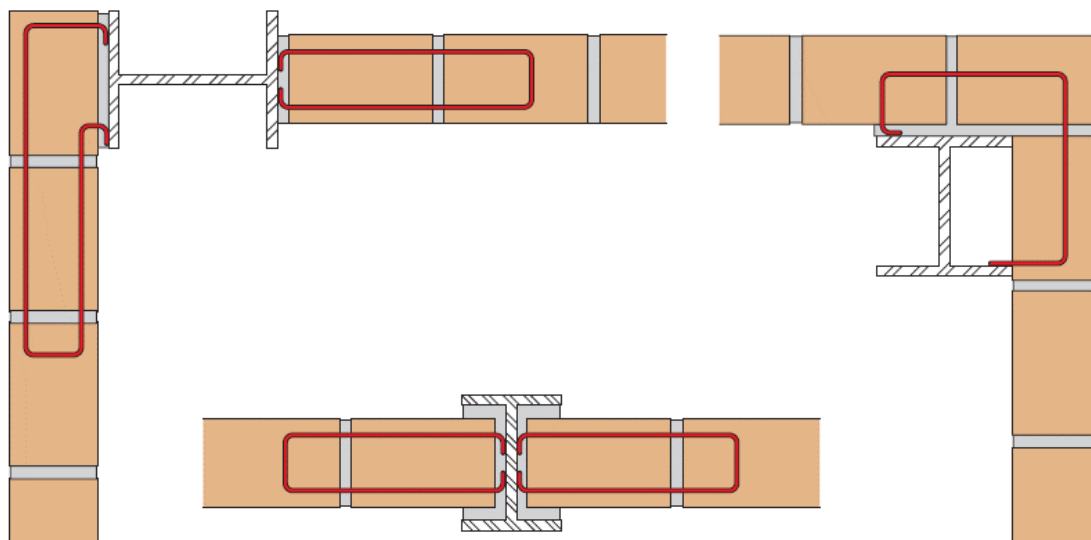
Ligações entre alvenarias e pilares de aço - estrutura aparente. Fonte: Thomaz et al. (2009).
